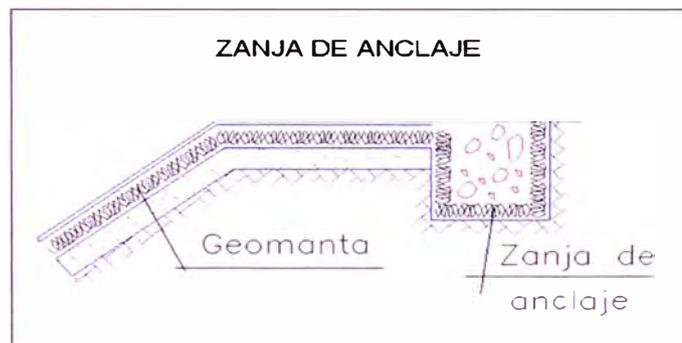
Detalle de zanja de anclaje y geomanta MacMat.
